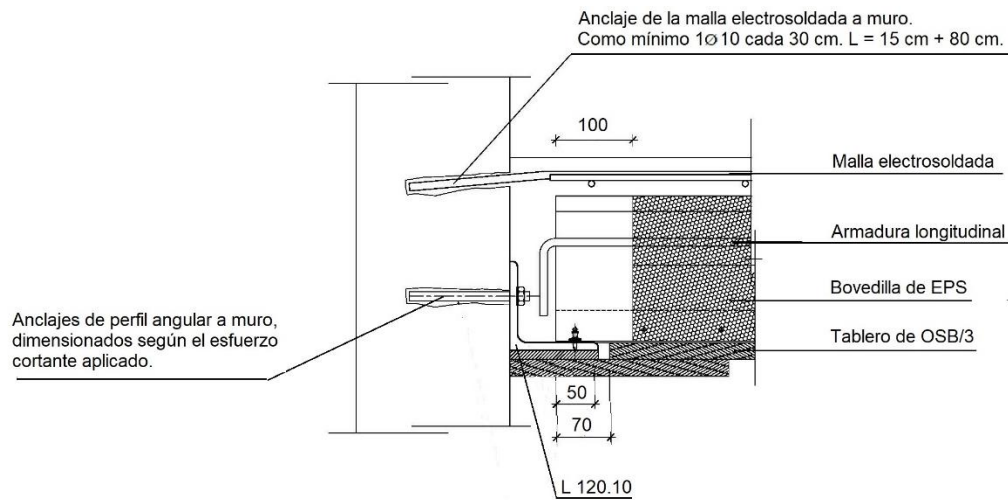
Apoyo frontal del forjado con el sistema SEST™ fijado a un muro.
